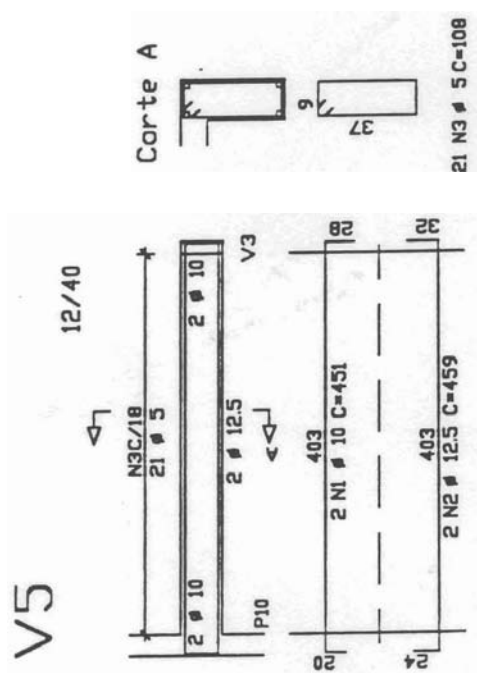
Detalhe de armadura da viga V5 (viga contínua)
